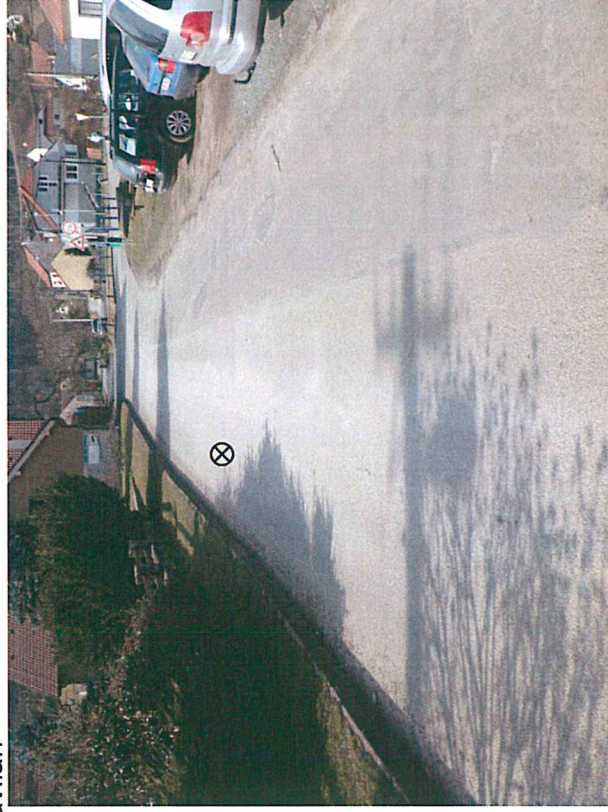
Detail místa odběru vývrtnu JV 1
